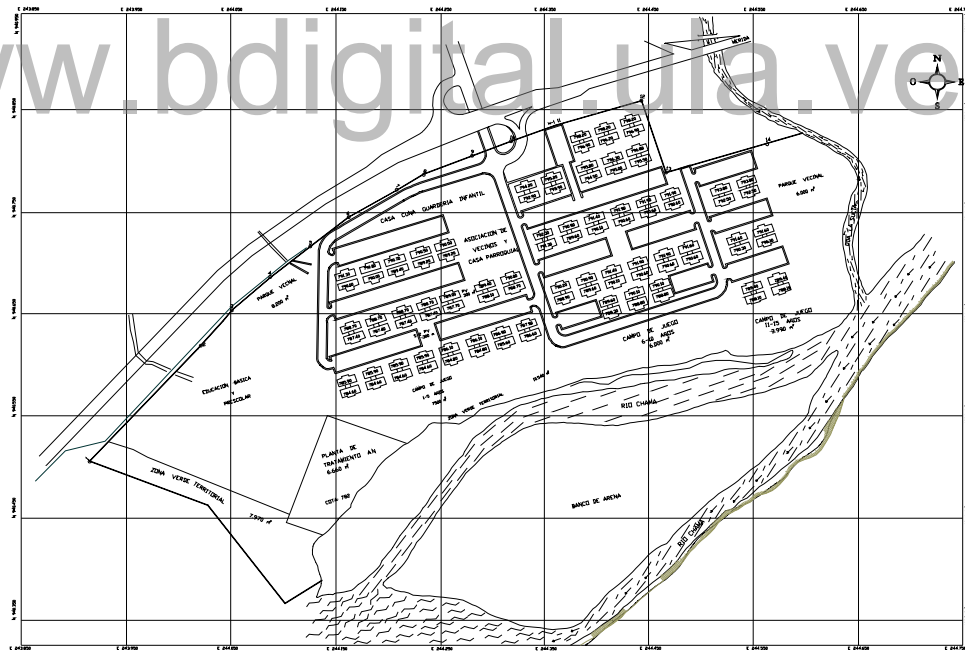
Plano de la sección sur de la urbanización Chama - Mérida
